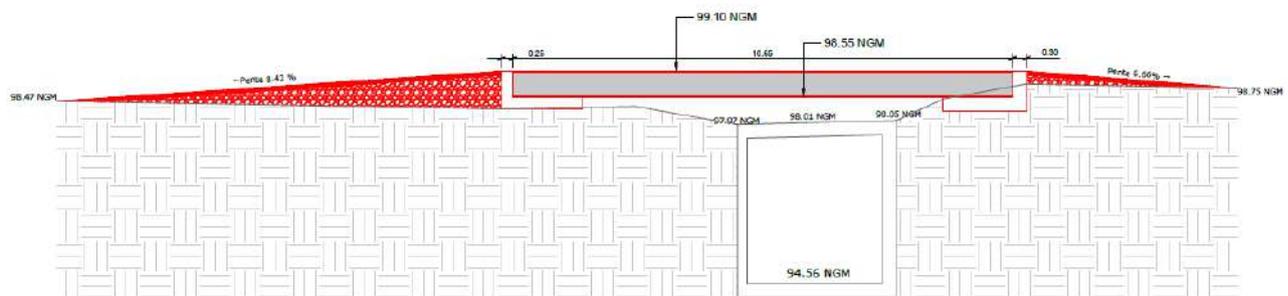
Coupe de longitudinale sur l'ouvrage provisoire
